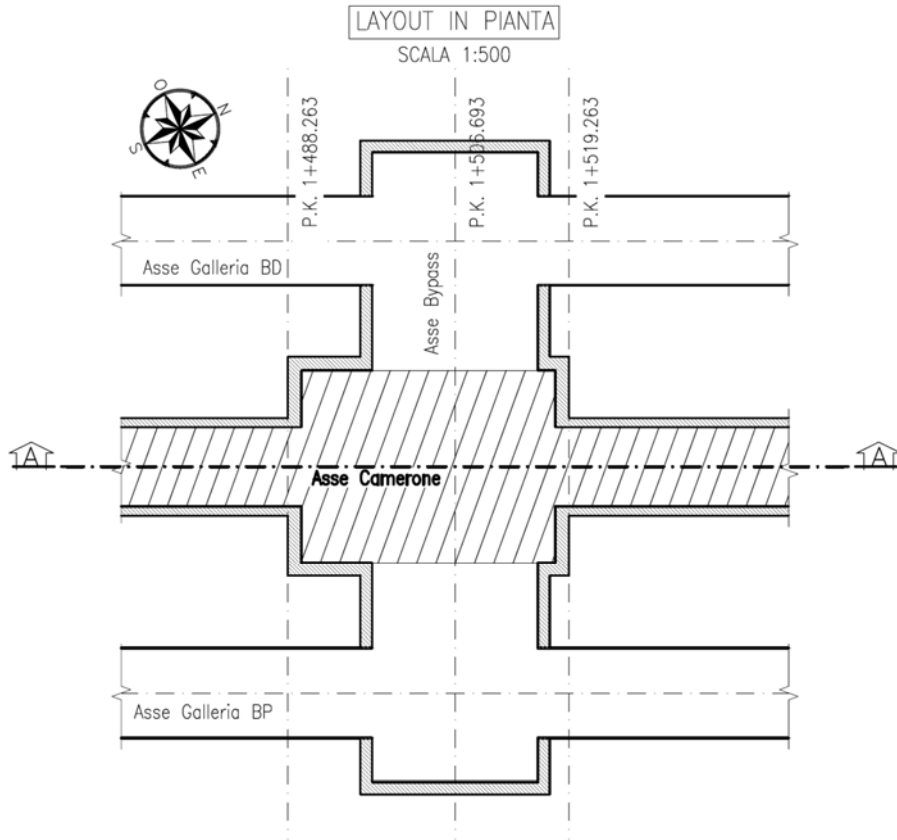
Camerone smontaggio TBM, fase 0, profilo longitudinale, planimetria, layout in pianta.
